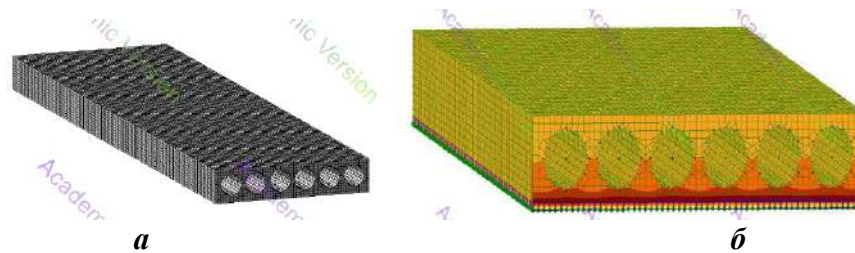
Модель залізобетонного перекриття в 3D (а, б) постановці: а – залізобетонне перекриття; б – вогнезахищене залізобетонне перекриття.
